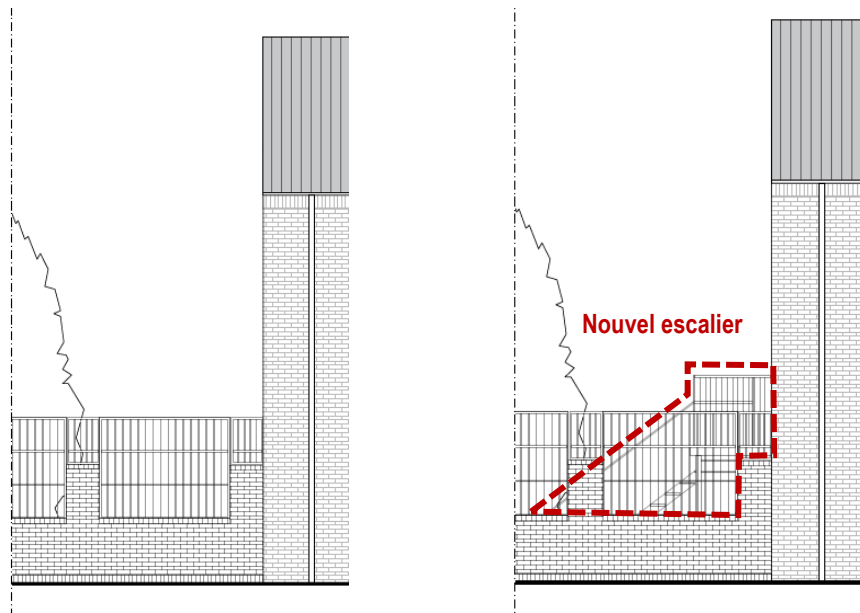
Détail de l'escalier prévue sur la façade latérale du bâtiment : situation existante (à gauche) vs. situation projetée (à droite) (Ville de Bruxelles, 2025)
